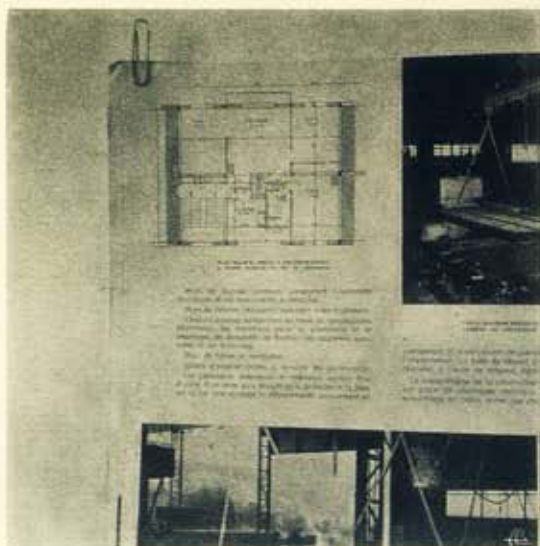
Planta das habitações em Grand-Quevilly — 4 divisões soalhadas.
